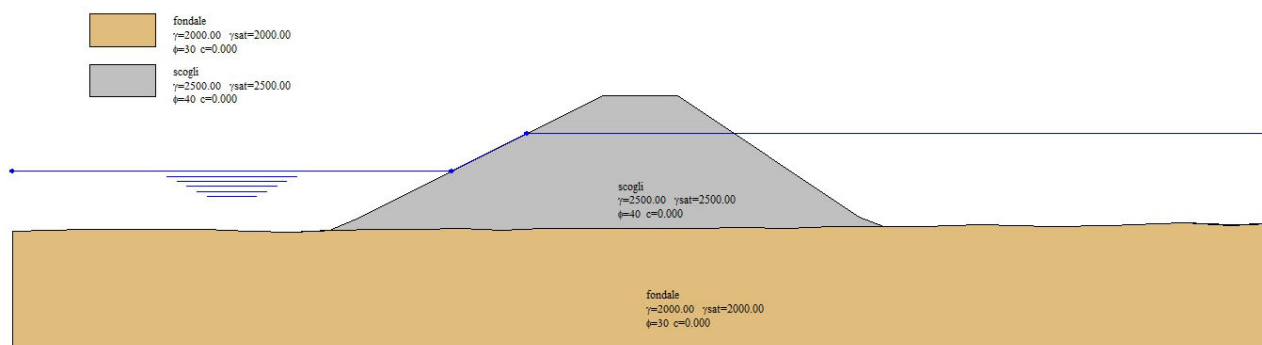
/1 – Profilo stratigrafico del terreno – sez. tipo progetto - pendenze 1:2 e 1:1.5 Rc=+1.50m
